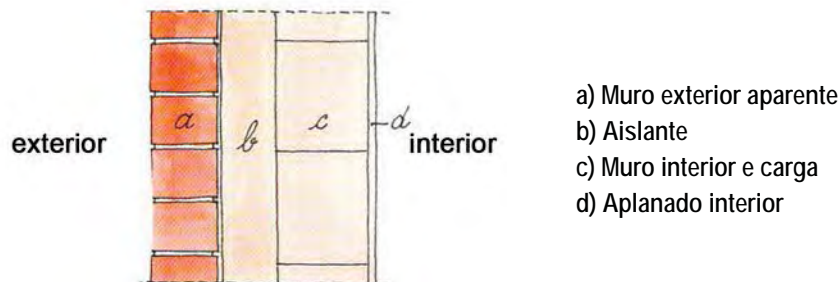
MURO DOBLE CON AISLAMIENTO CENTRAL
